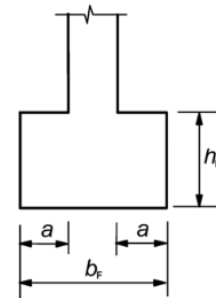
Unbewehrte Stützenfundamente; Bezeichnungen
